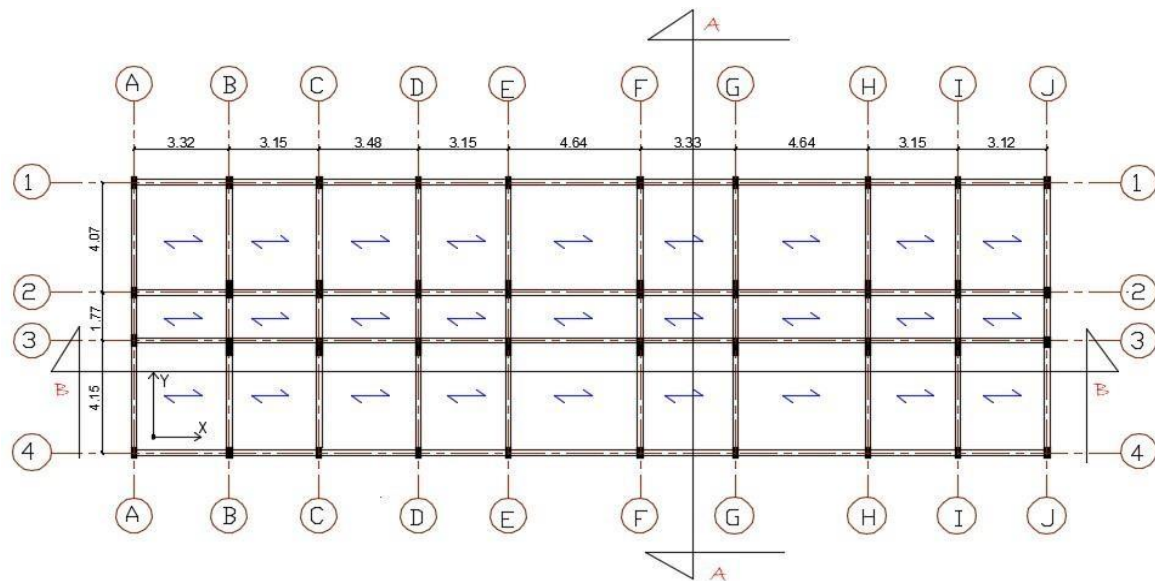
Plan de coffrage de l'ensemble des planchers haut du rez-de-chaussée à l'étage 5 du bloc B
